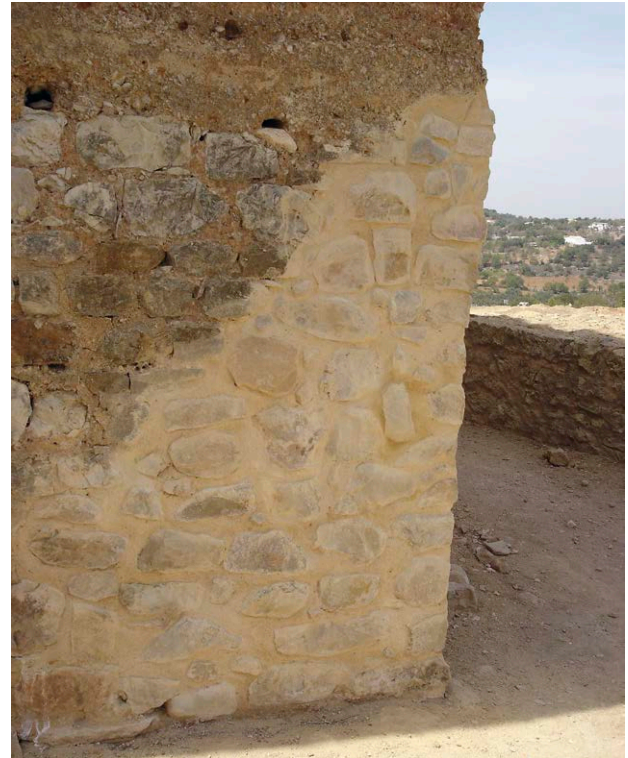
Relleno de laguna en esquina con mampostería de piedra
